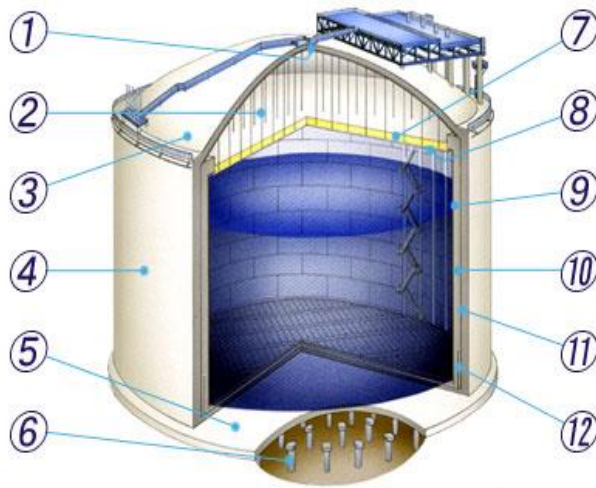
Залізобетонний ізотермічний резервуар із замкненою зовнішньою оболонкою: 1 – підкладка даху; 2 – підвіска; 3 – залізобетонний дах; 4 – бічна стінка з портландцементу; 5 – залізобетонна стіна основи; 6 – залізобетонні палі; 7 - ізоляція даху; 8 – підвісна платформа; 9 – внутрішній корпус; 10 - теплоізоляція стінки резервуара; 11 - підкладка; 12 – вторинна перегородка
